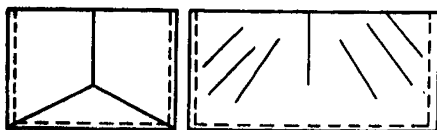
Схема разрушения плит с опиранием по трем сторонам
